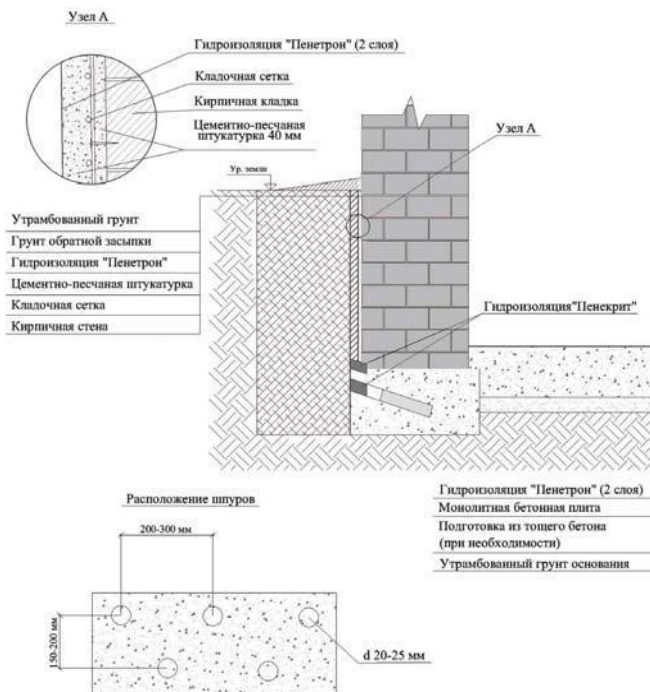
Устройство внешней гидроизоляции по кирпичной стене
